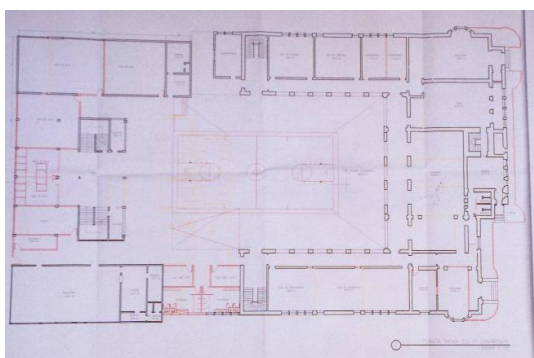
Planta baixa 1º pav. Grupo Escolar D. Pedro II atualmente. Fonte: Departamento Geral da Rede Física da
